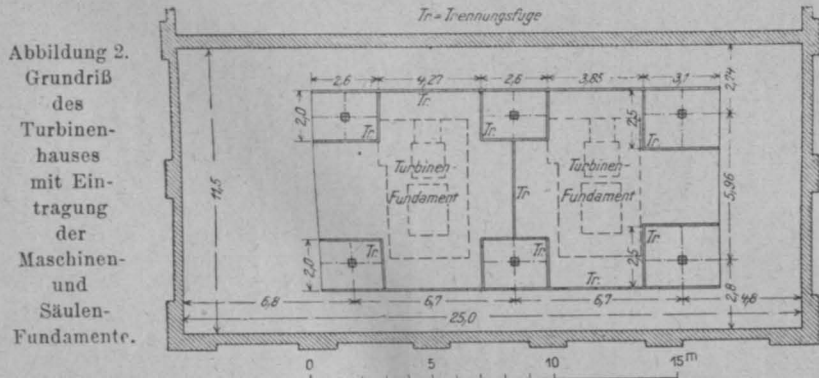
Grundriß des Turbinenhauses mit Eintragung der Maschinen- und Säulen-Fundamente.
